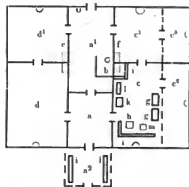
Grundriss des geteilten größeren Wohnhauses.
